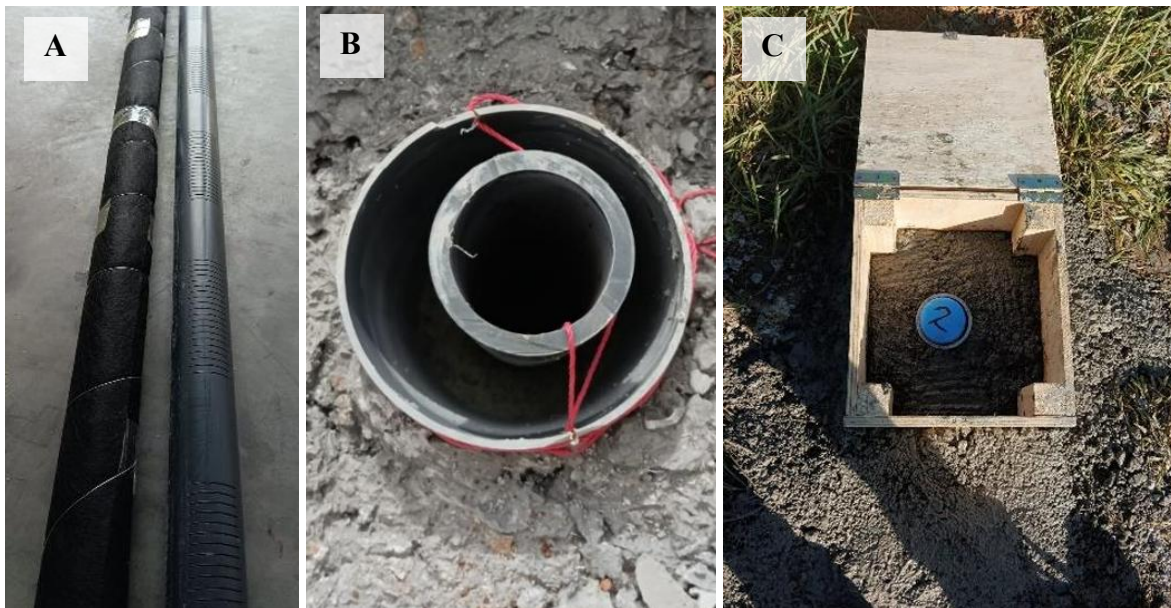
Fotografías de piezómetros instalados en zona de estudio, (A) tubo piezométrico con y sin geotextil, (B) piezómetro y tubo de revestimiento, y (c) emplentillado de lechada de cemento y caja de protección de piezómetros.
